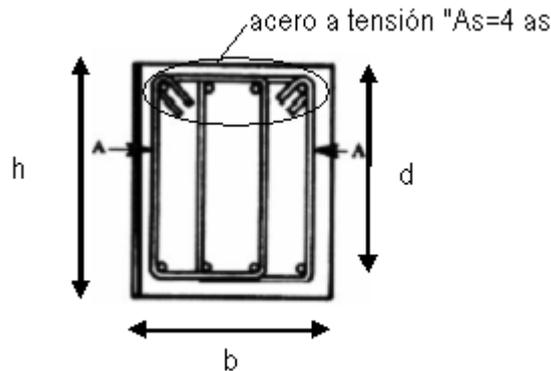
b) Algunos de los posibles arreglos y requisitos de detalle.
